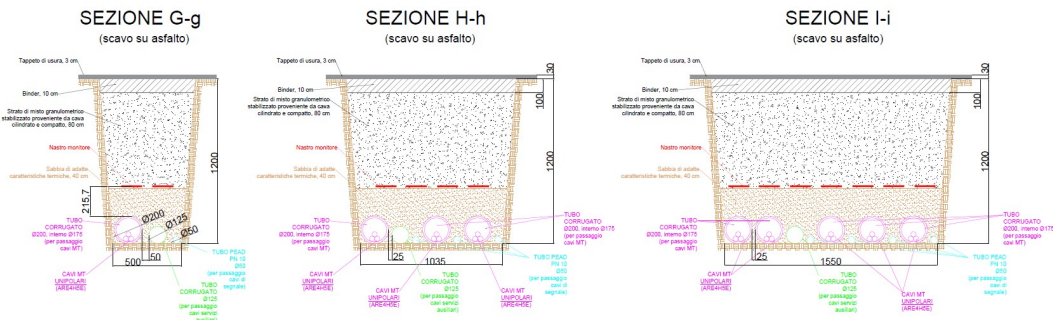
Sezioni G, sezione H e sezione I della trincea di scavo per la posa del cavo MT 30 kV di collegamento dall'impianto FV all'ampliamento della Stazione Elettrica
